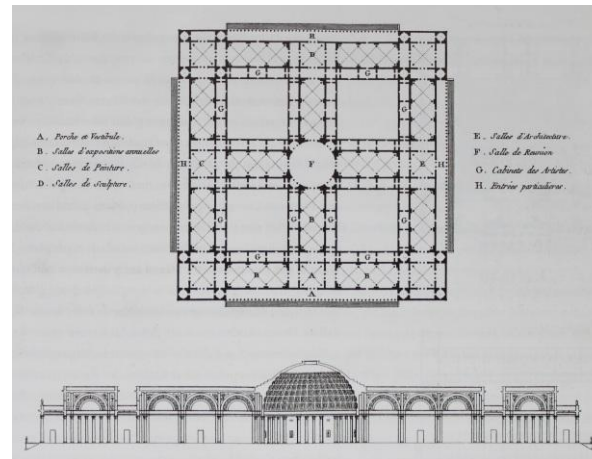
Jean-Nicolas-Louis Durand, Entwurf eines Museums, Grundriss und Schnitt, Paris 2008
